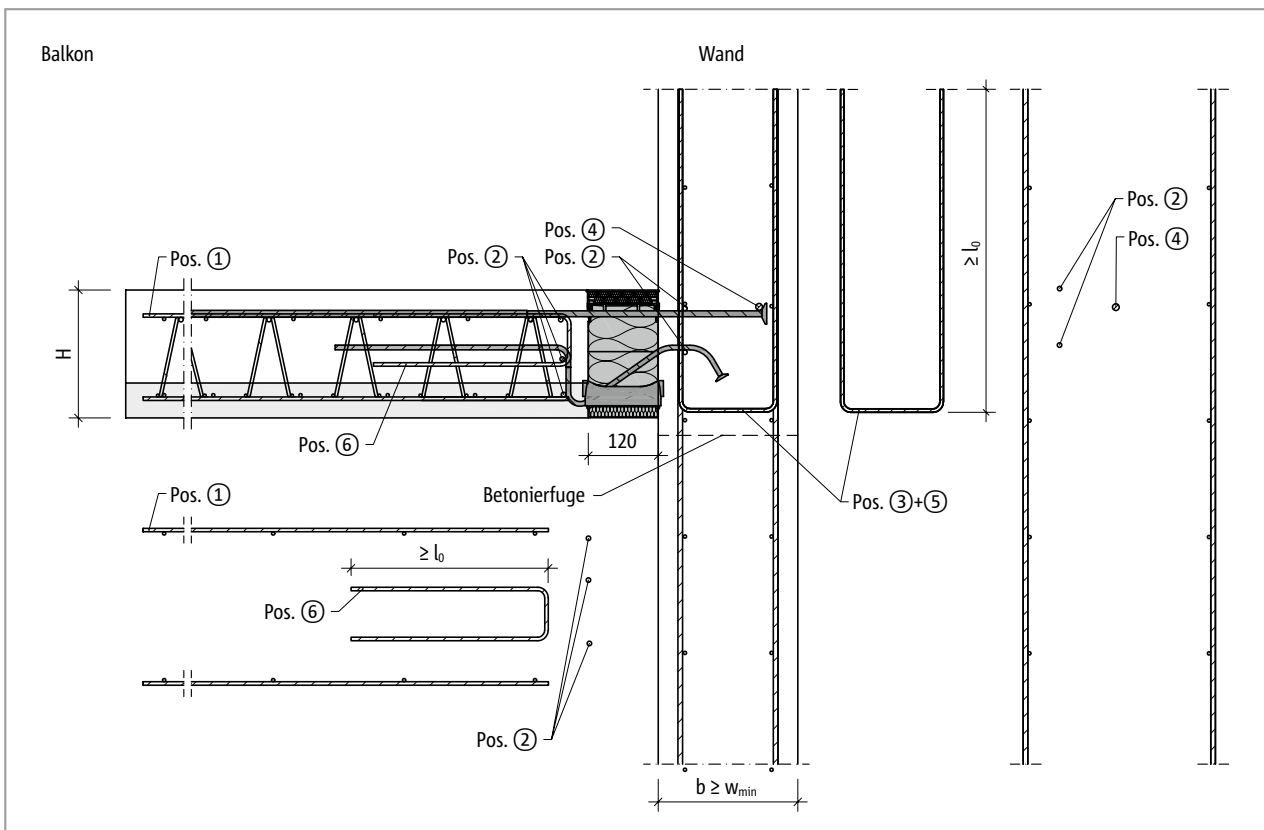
Schöck Isokorb® XT Typ K-U-F: Bauseitige Bewehrung für Wandanschluss nach oben
